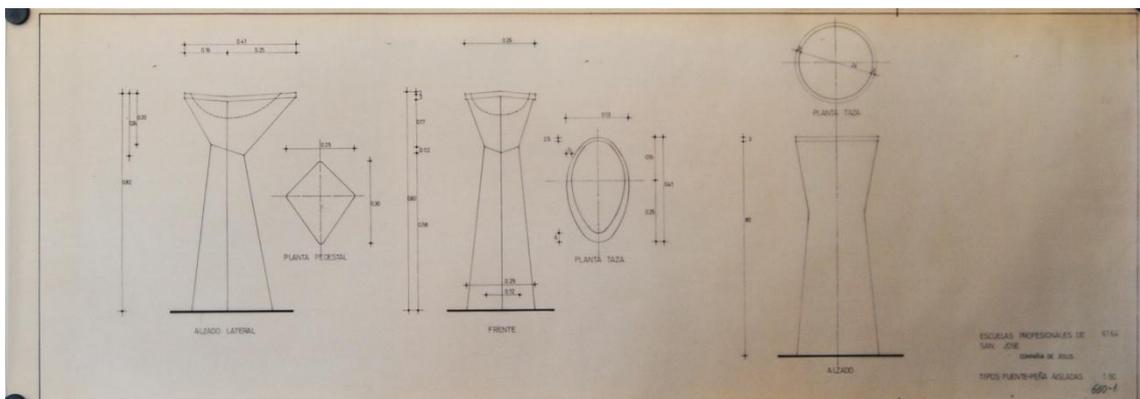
Plano de detalle de tipo de fuentes. Archivo Escuelas San José.
